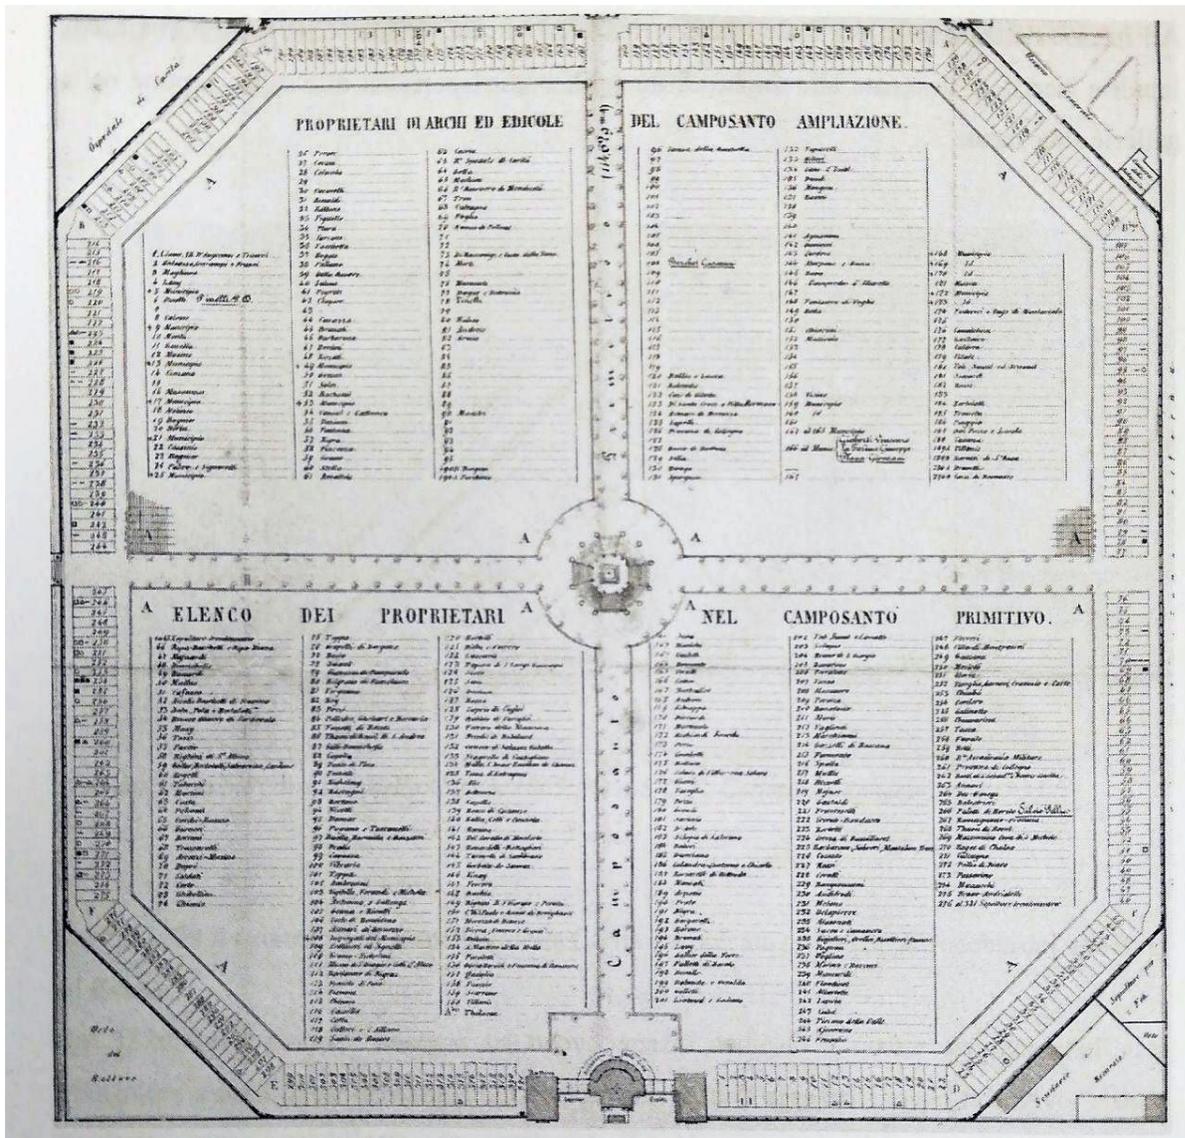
Planimetria raffigurante la sistemazione del Campo Primitivo e delle aree triangolari (Archivio Storico della Città di Torino - Collezione Simeom - SIM D 553).
